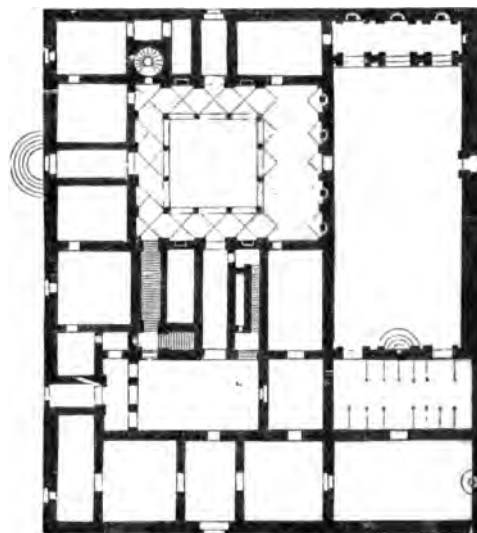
Pal. Riccardi zu Florenz. Grundriss.
